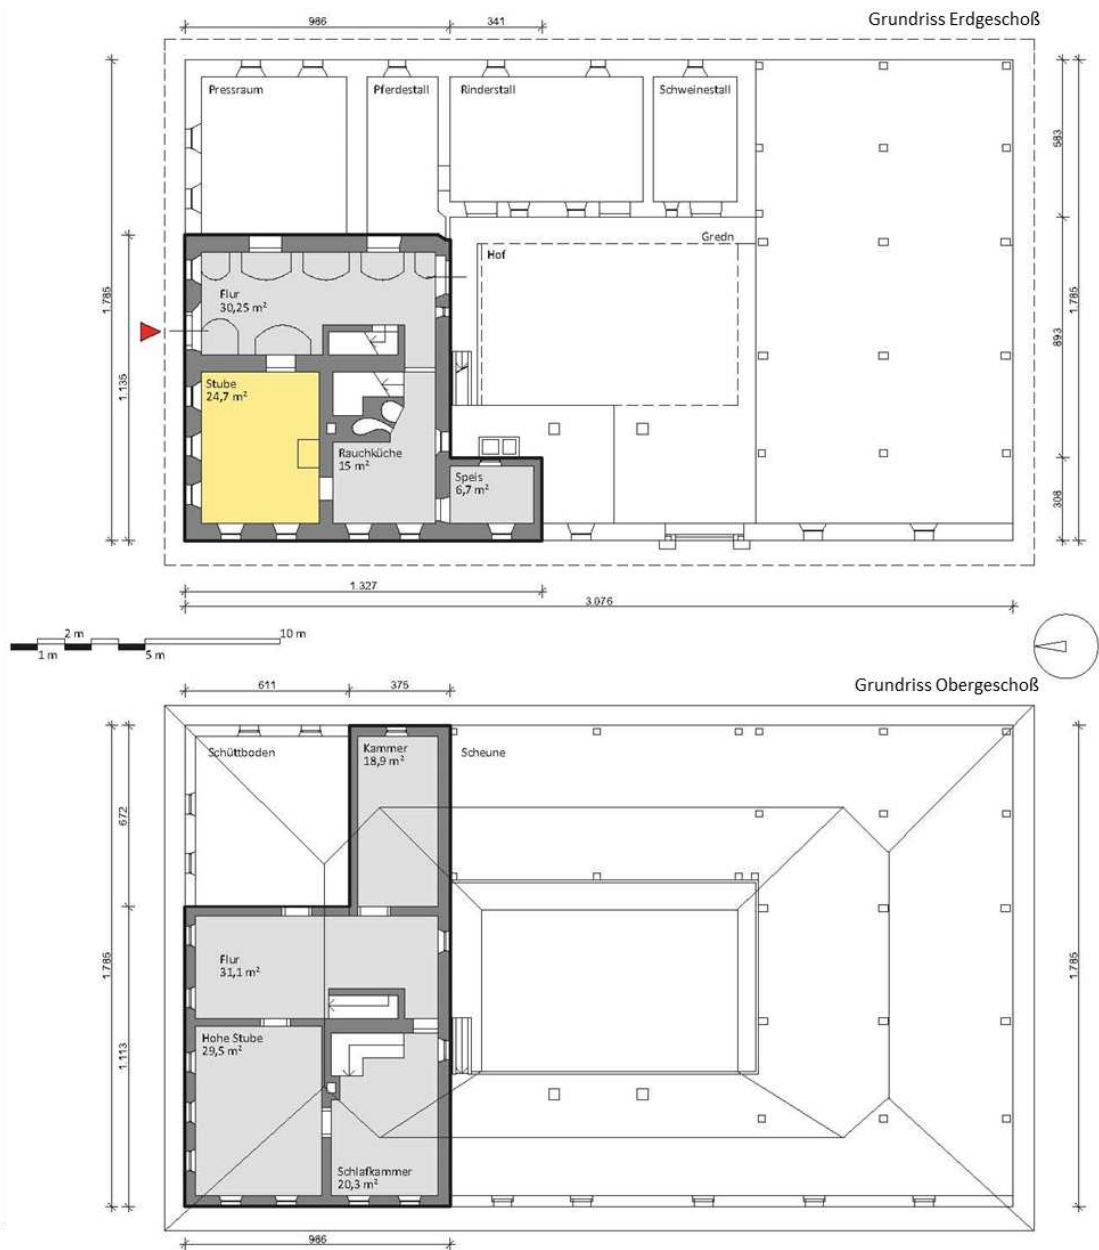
Grundrissdarstellung von Erd- und Obergeschoß des Wohnbereiches
